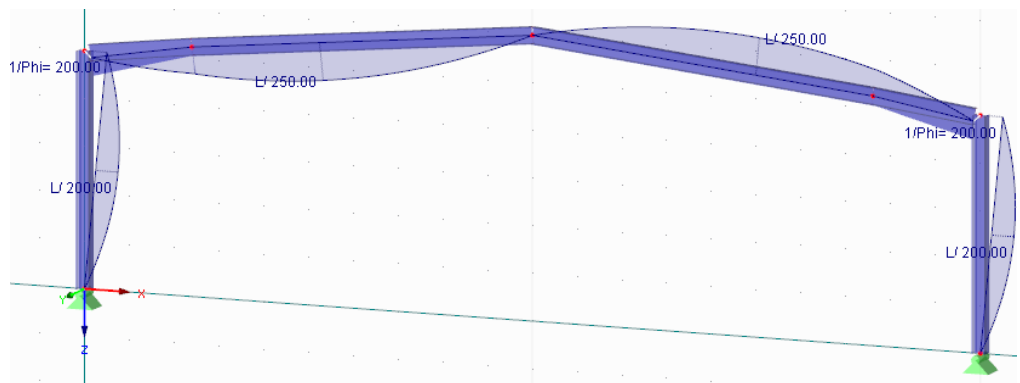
Les imperfections pour les poteaux et les poutres horizontales
